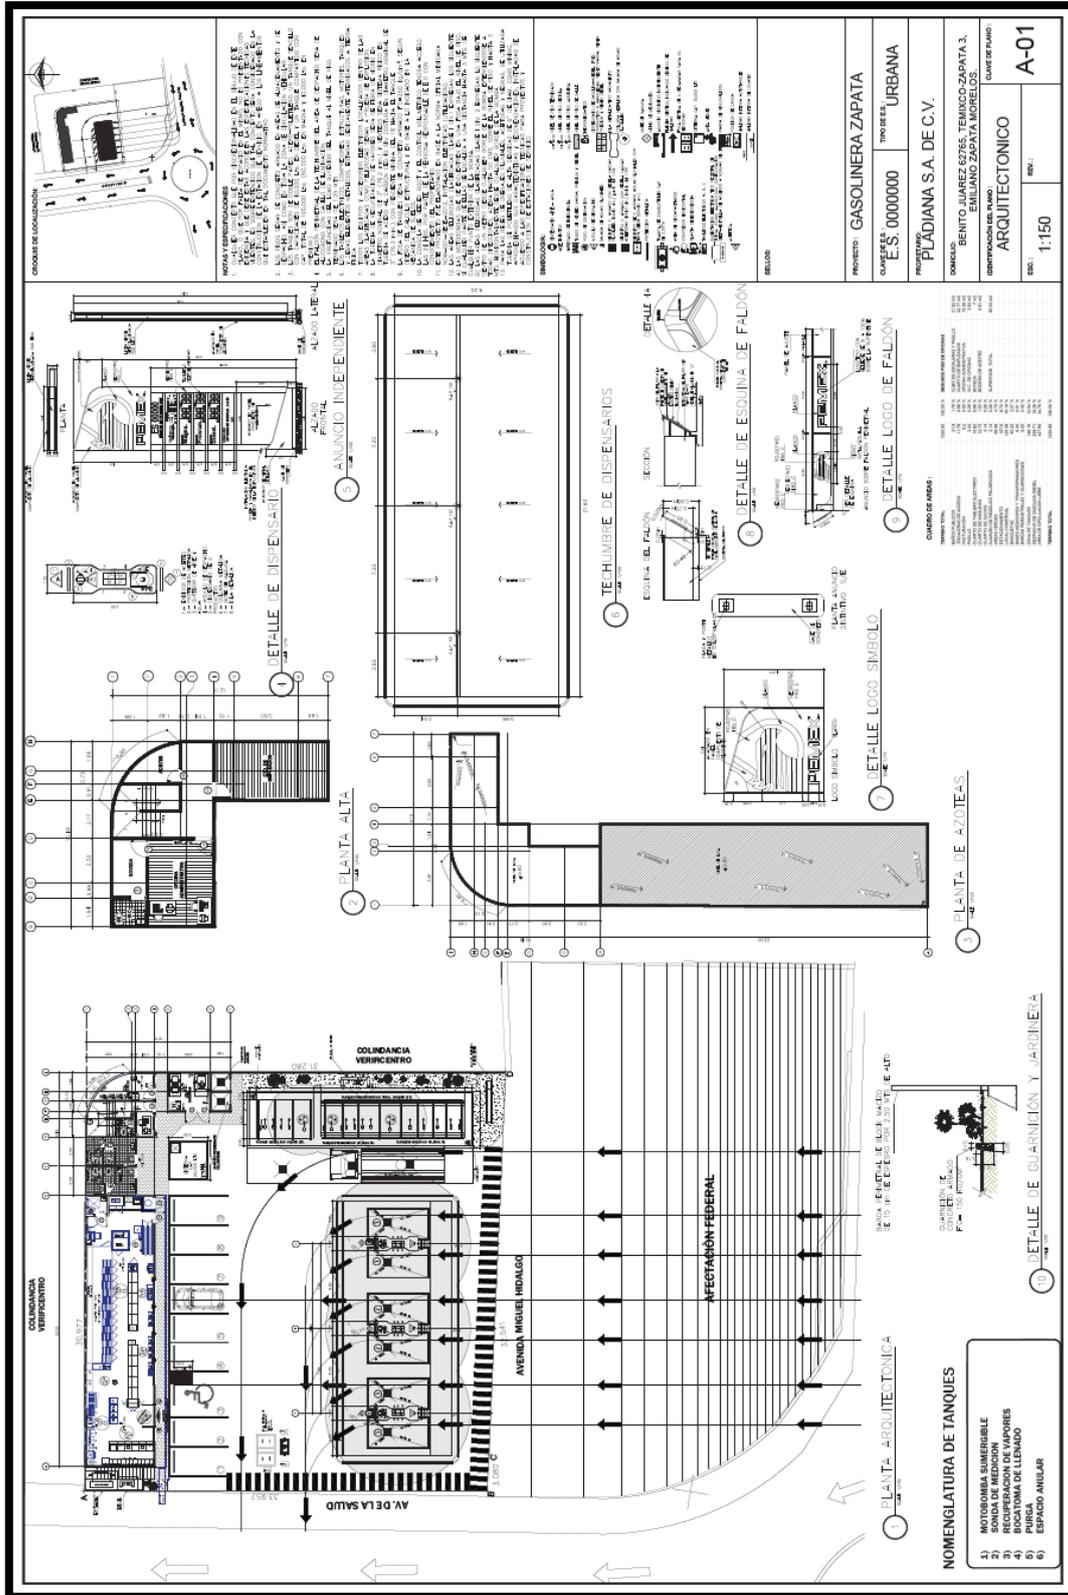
Plano de Conjunto de PLADIANA S.A. DE C.V.
